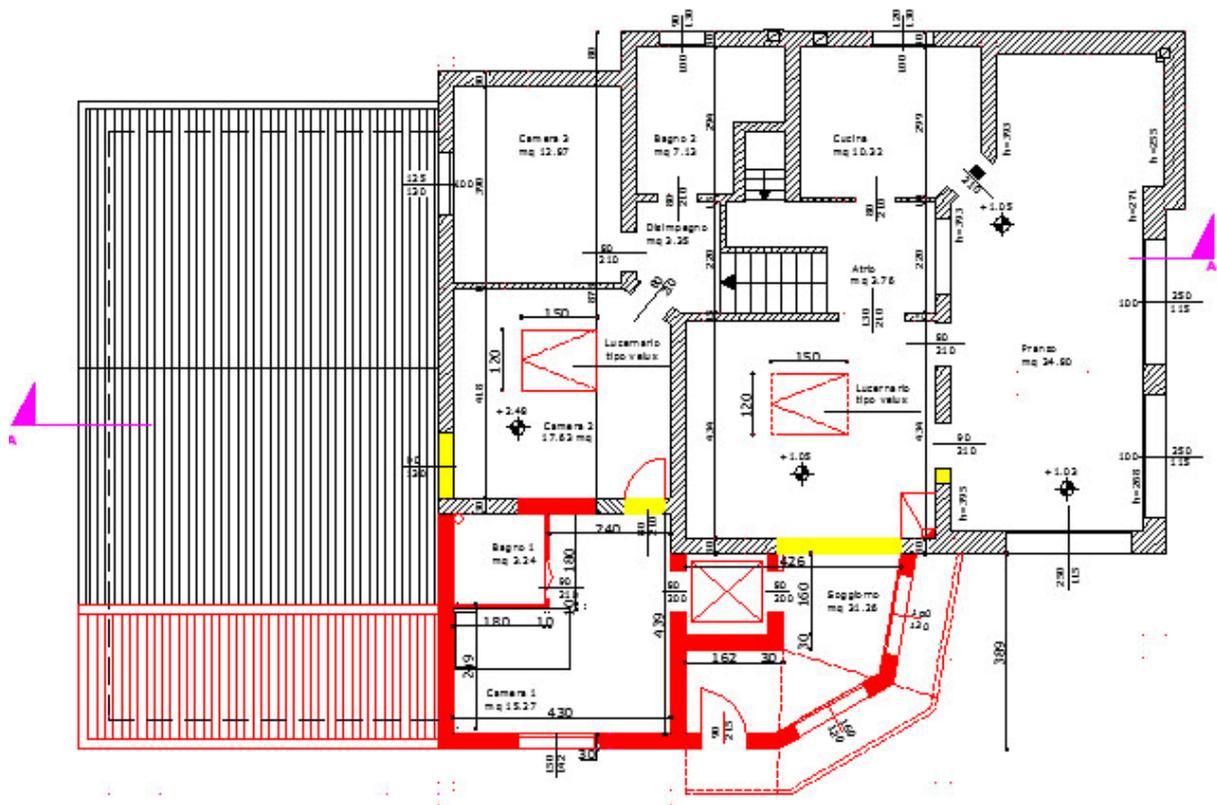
Planimetria del piano rialzato e primo piano stato di progetto
